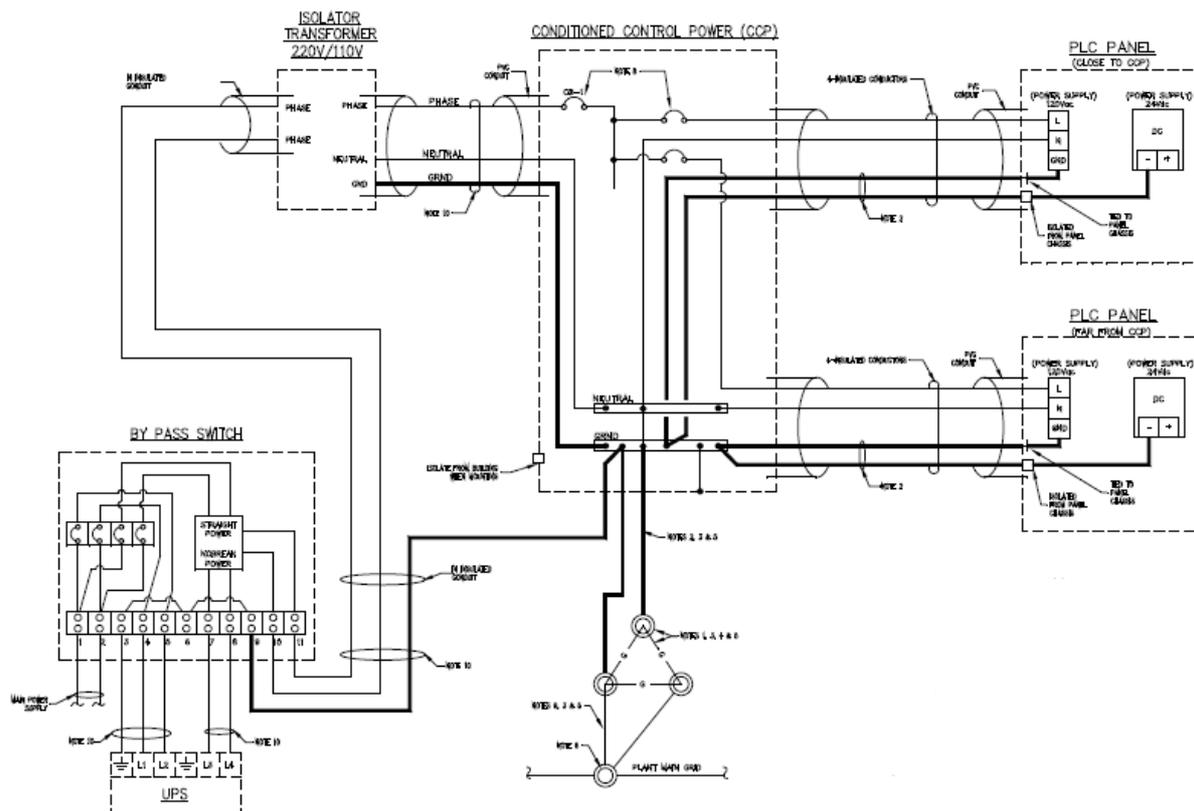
Sistema de aterramento da Instrumentação, utilizado na White Martins
